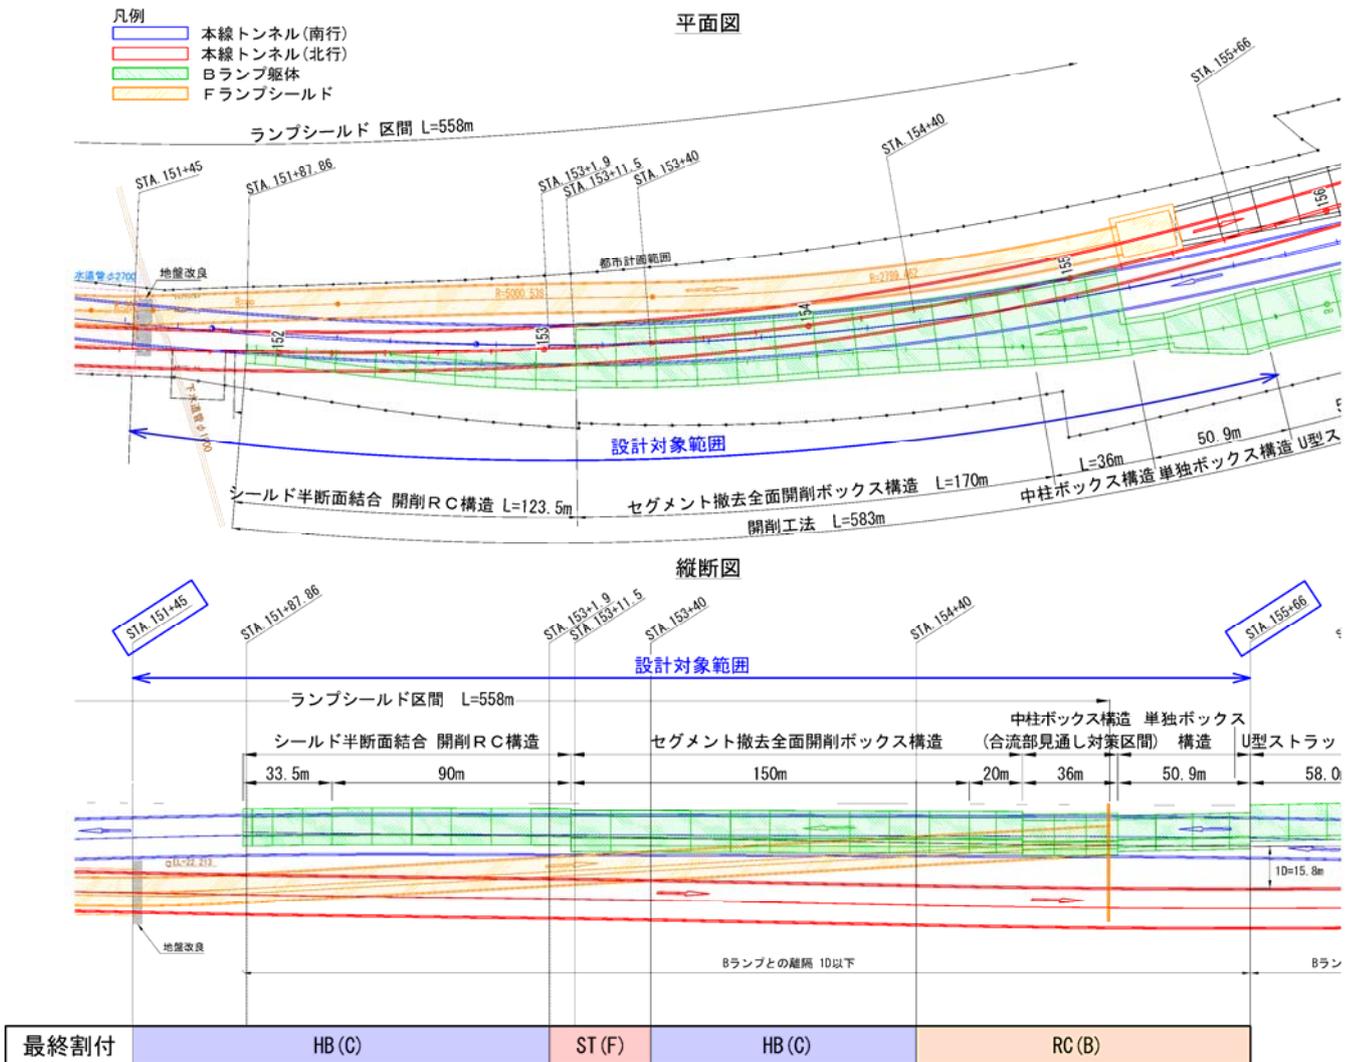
大泉JCT上部開削検討対象区間平面図および縦断面図
